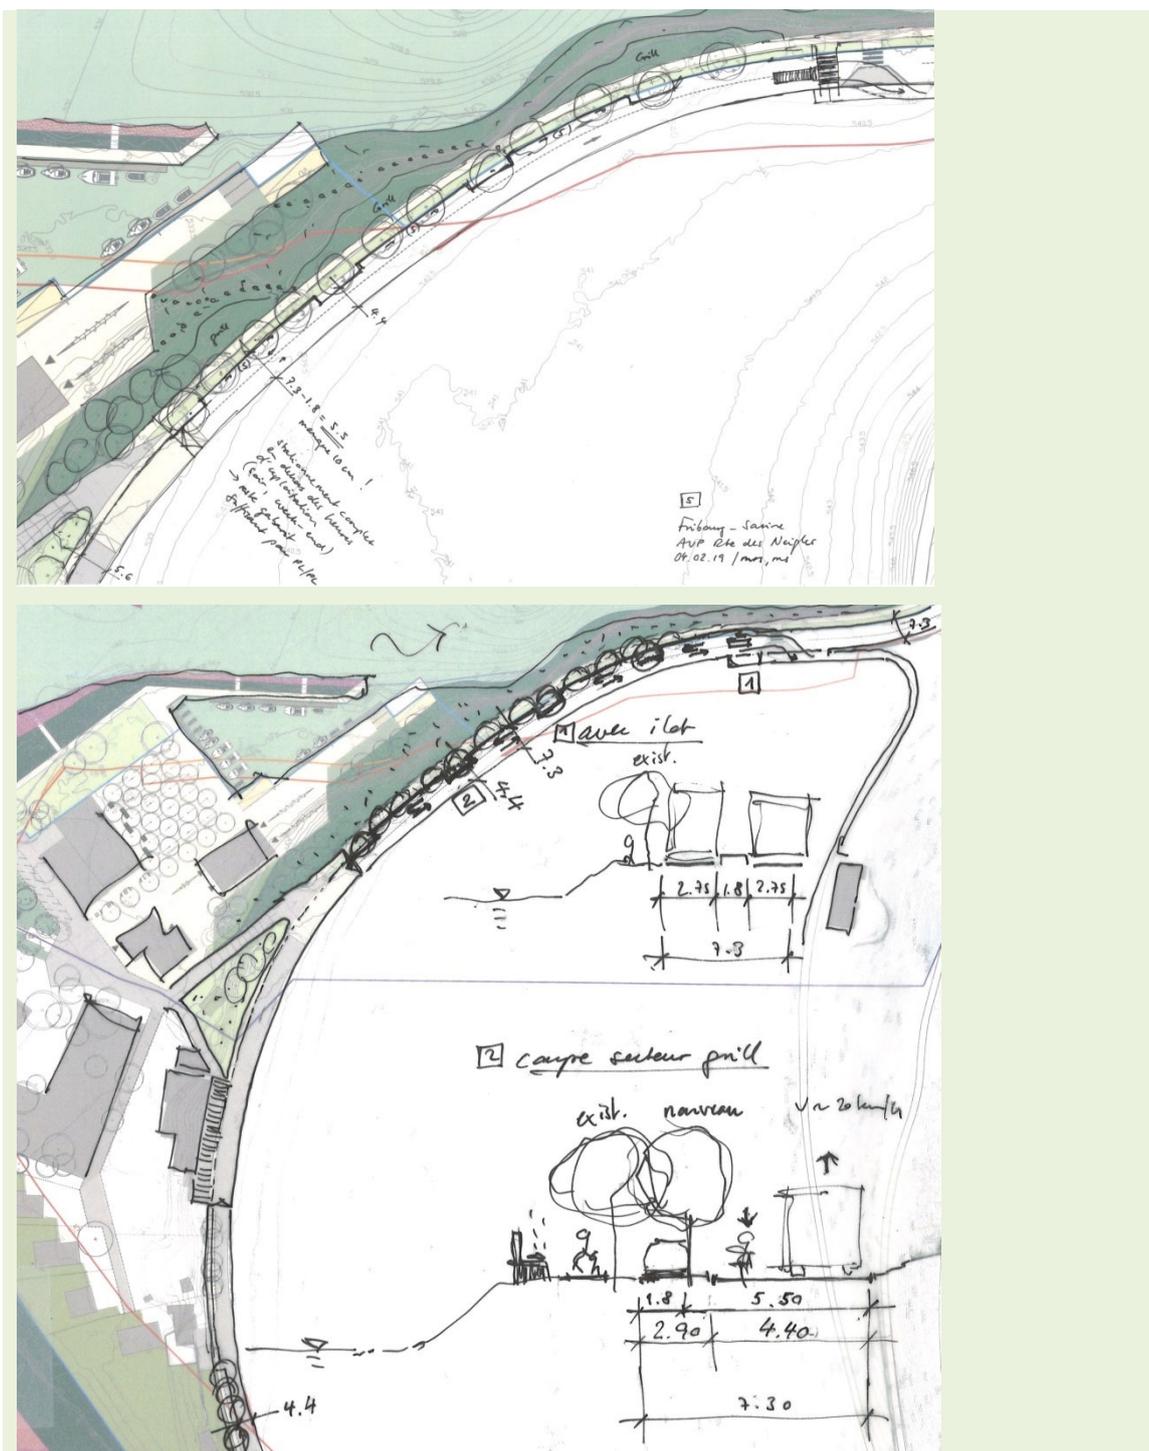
Proposition optionnelle pour le tronçon en balcon sur la Sarine vers le port de plaisance : aires de pique-nique avec foyers pré-installés, directement accessible depuis route et sans nuire aux berges, avec stationnement latéral (si accepté) qui ramène à une chaussée de 5.5m hors resserrement (admissible car stationnement hors des heures PL).
